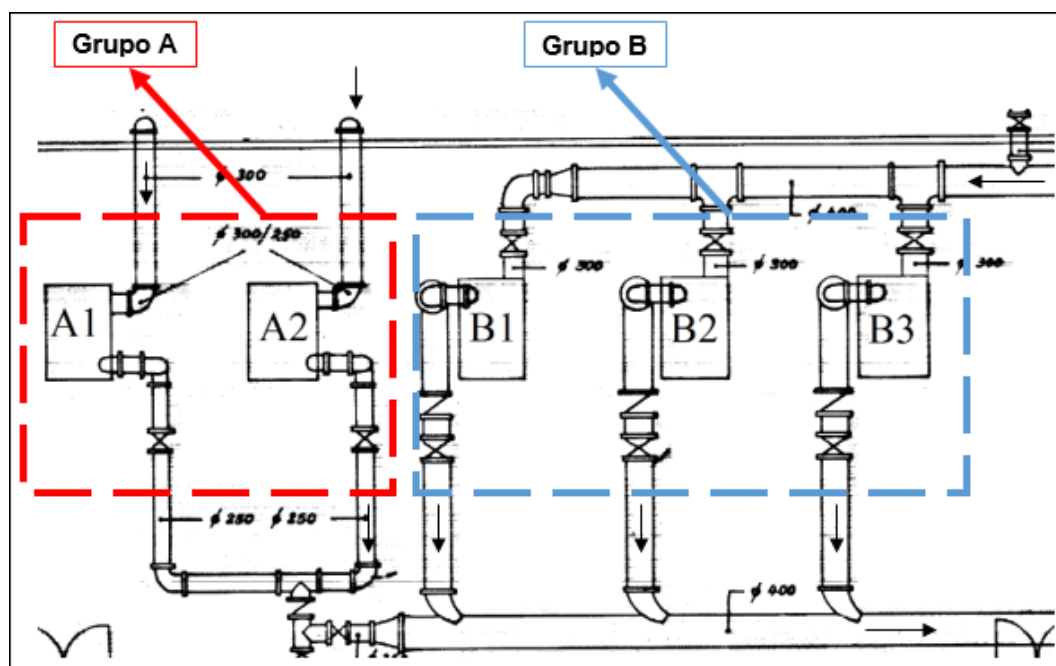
Esquema da planta da Estação Elevatória de Vale de Milhaços
